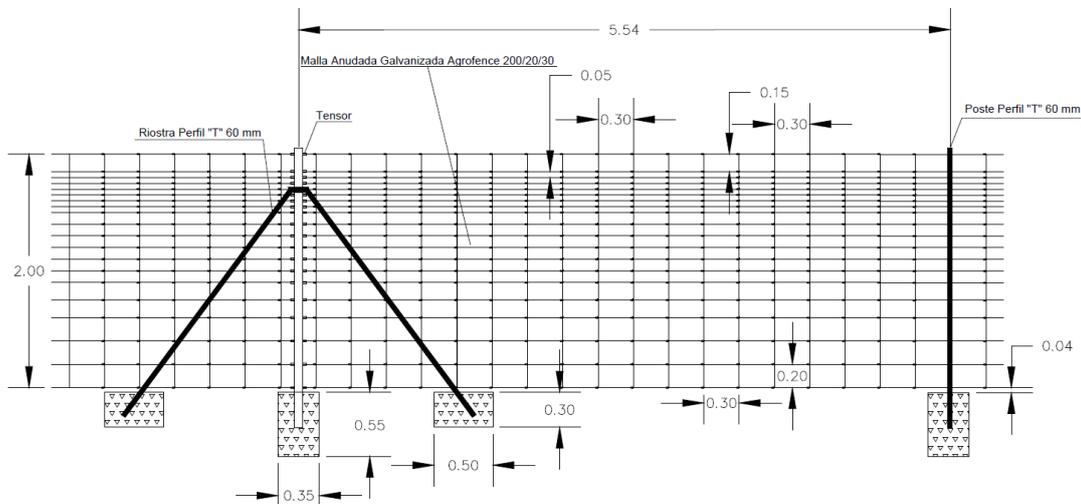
Detalle vallado cinético (Fuente: Externa)
